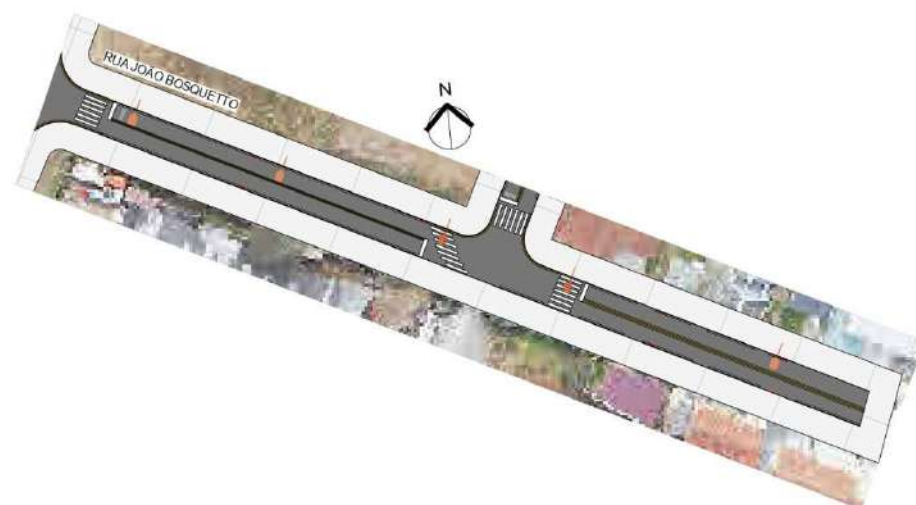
FOTOS DA RUA JOÃO BOSQUETTO
